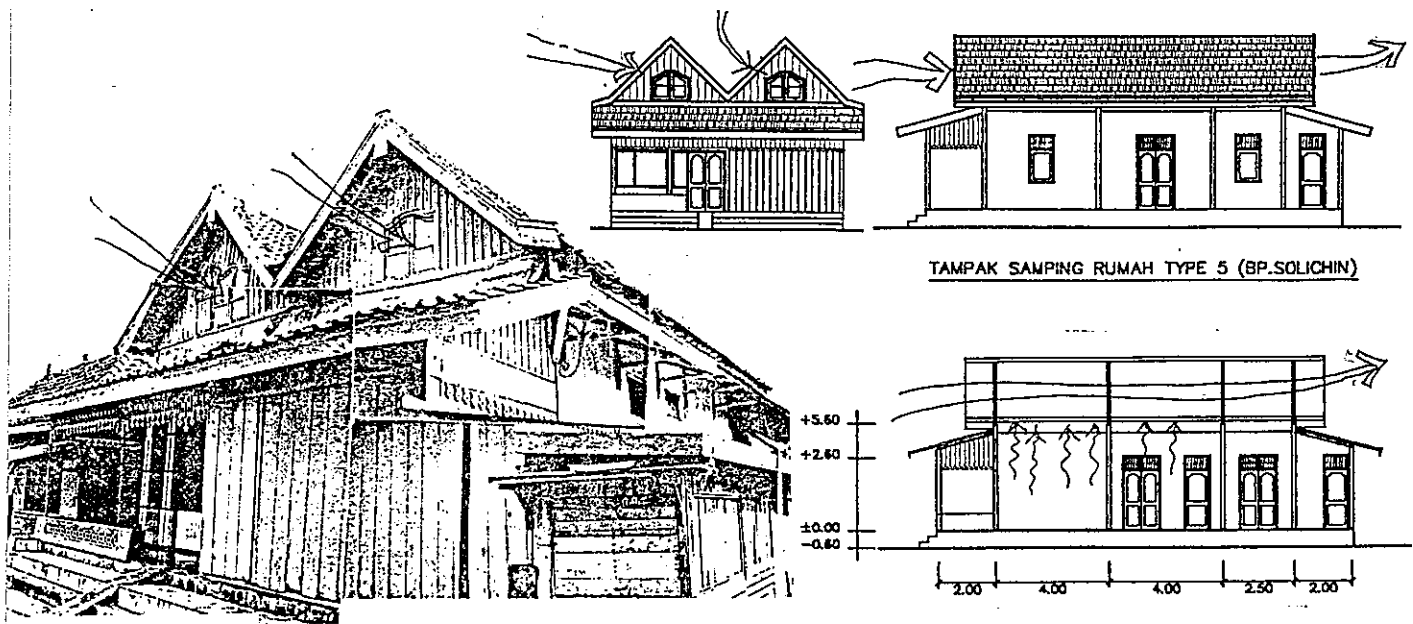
Gambar denah tampak potongan Rumah 5
